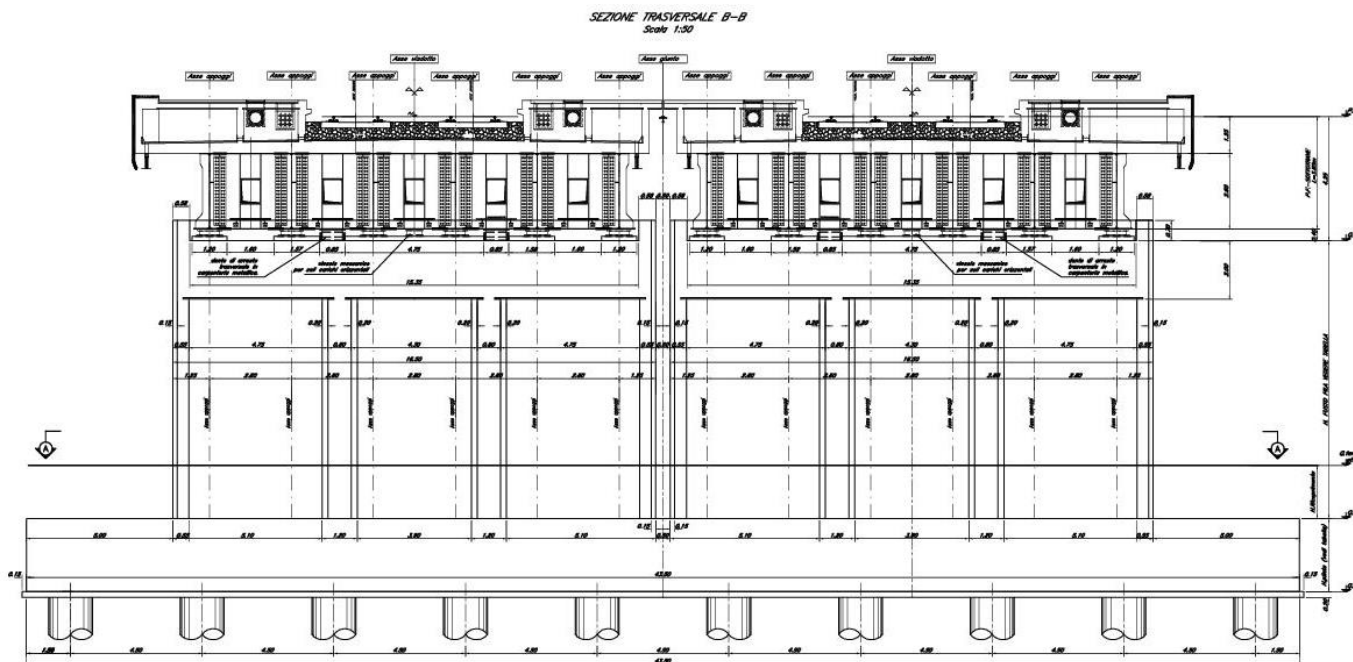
Prospetto Pila P02 - P05 -sezione trasversale
